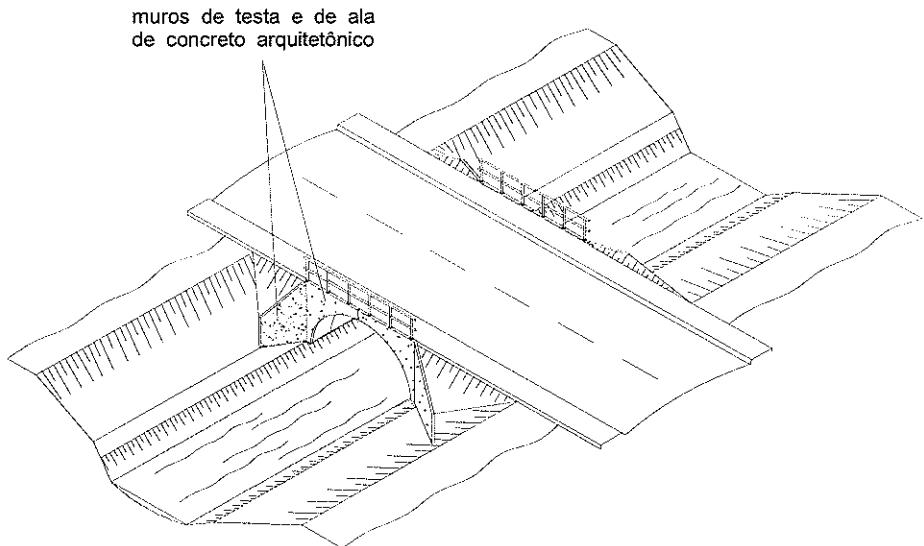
Execução do guarda corpo, do aterro, passeio e pavimentação (término da construção)
